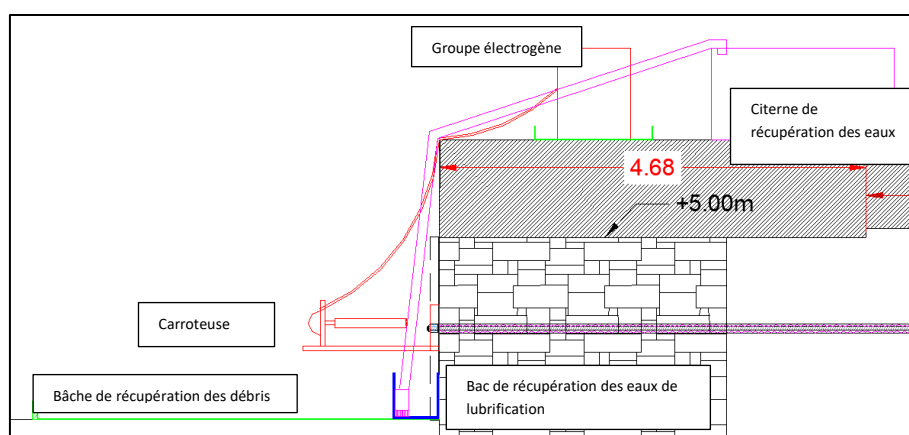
Coupe de principe de la mise en place d'un tirant traversant
